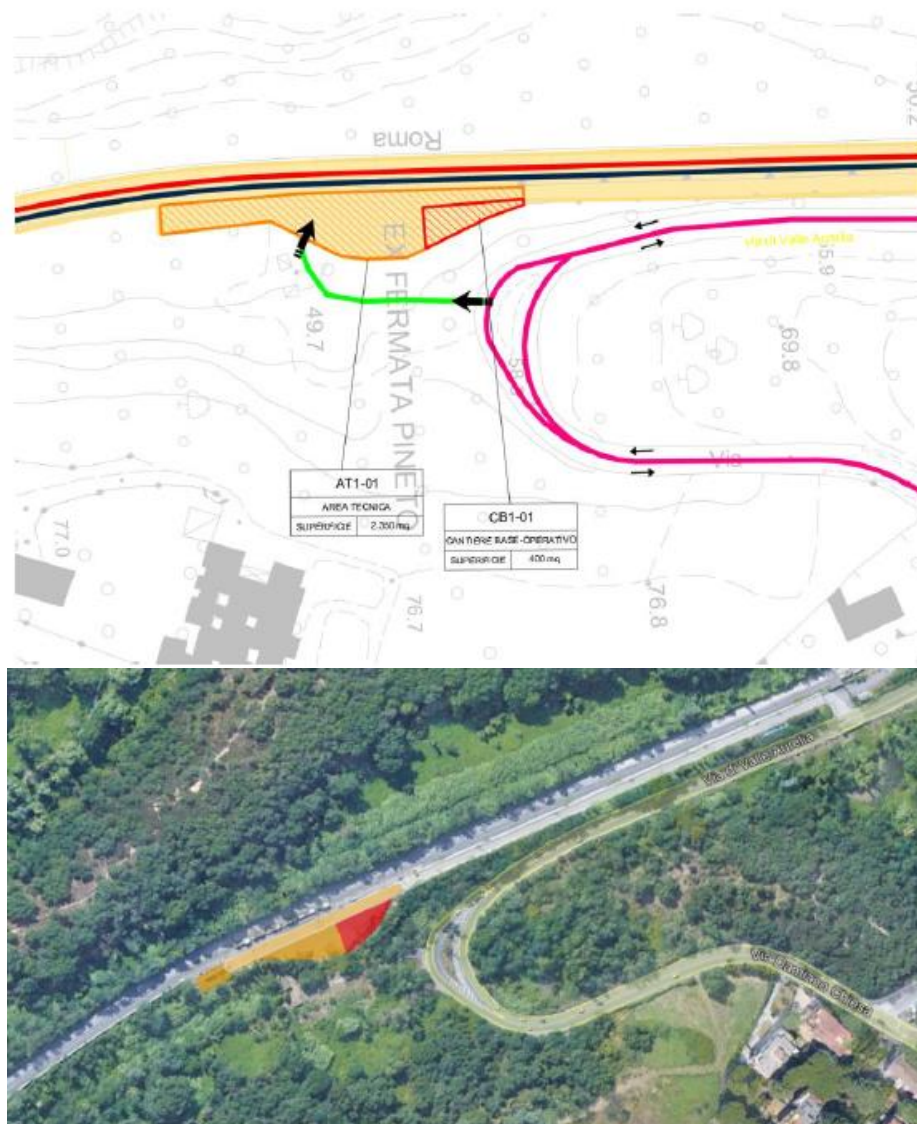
Vista planimetrica cantiere di base e area tecnica
